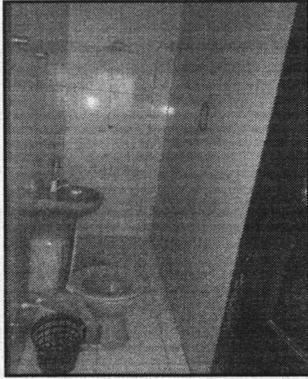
Vista da Banheiro, com destaque ao revestimento cerâmico em paredes e piso
